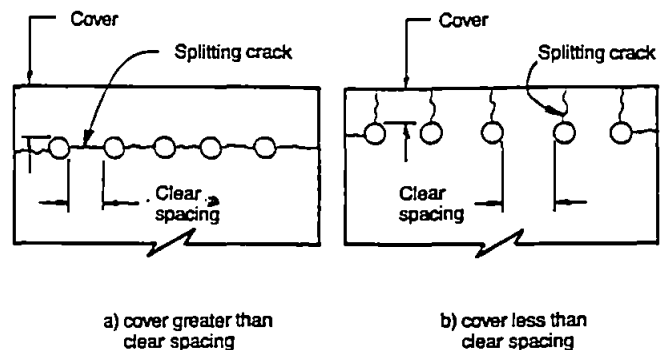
Grietas por Hendidamiento-Barras en tracción
